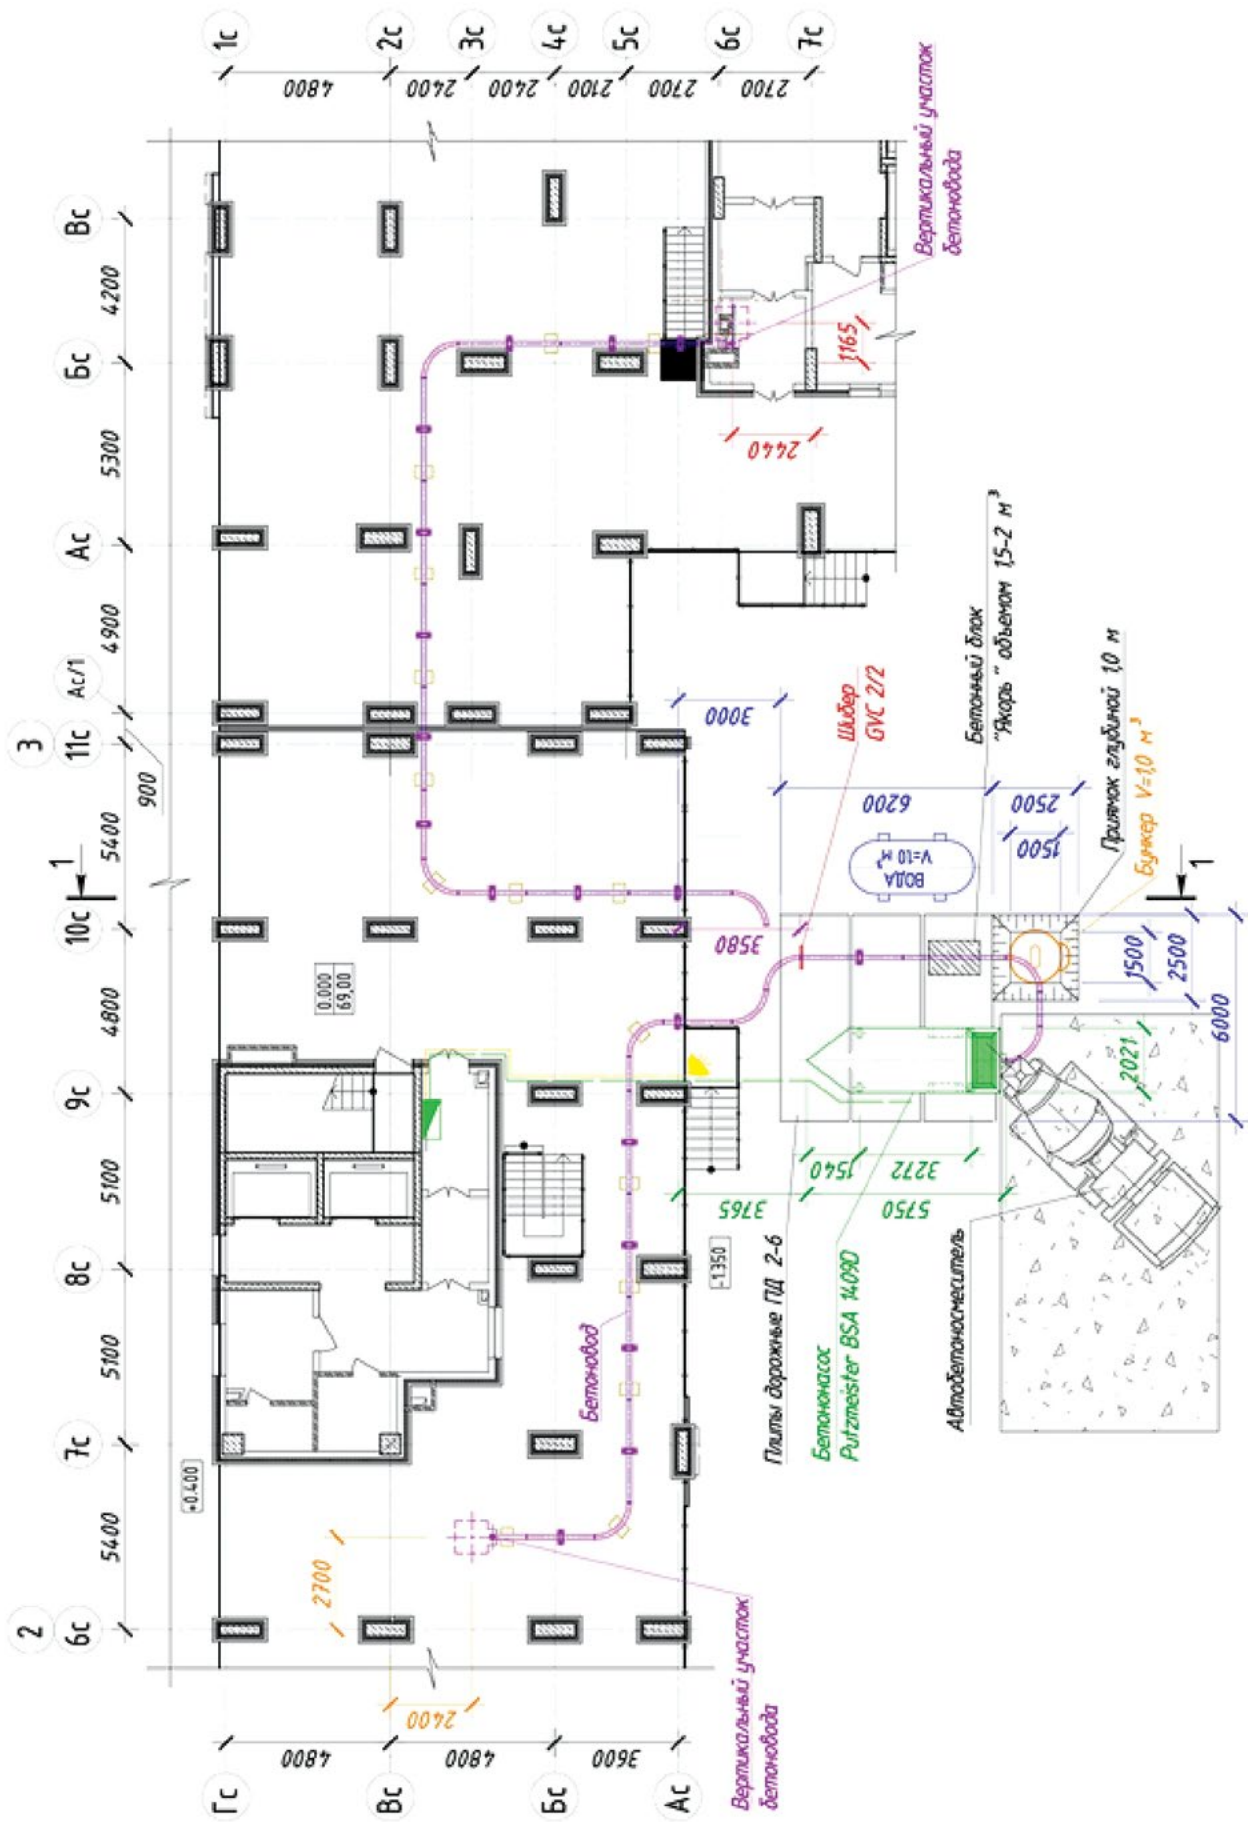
Схема расположения бетононасоса и бетоноводов на 1-м этаже
